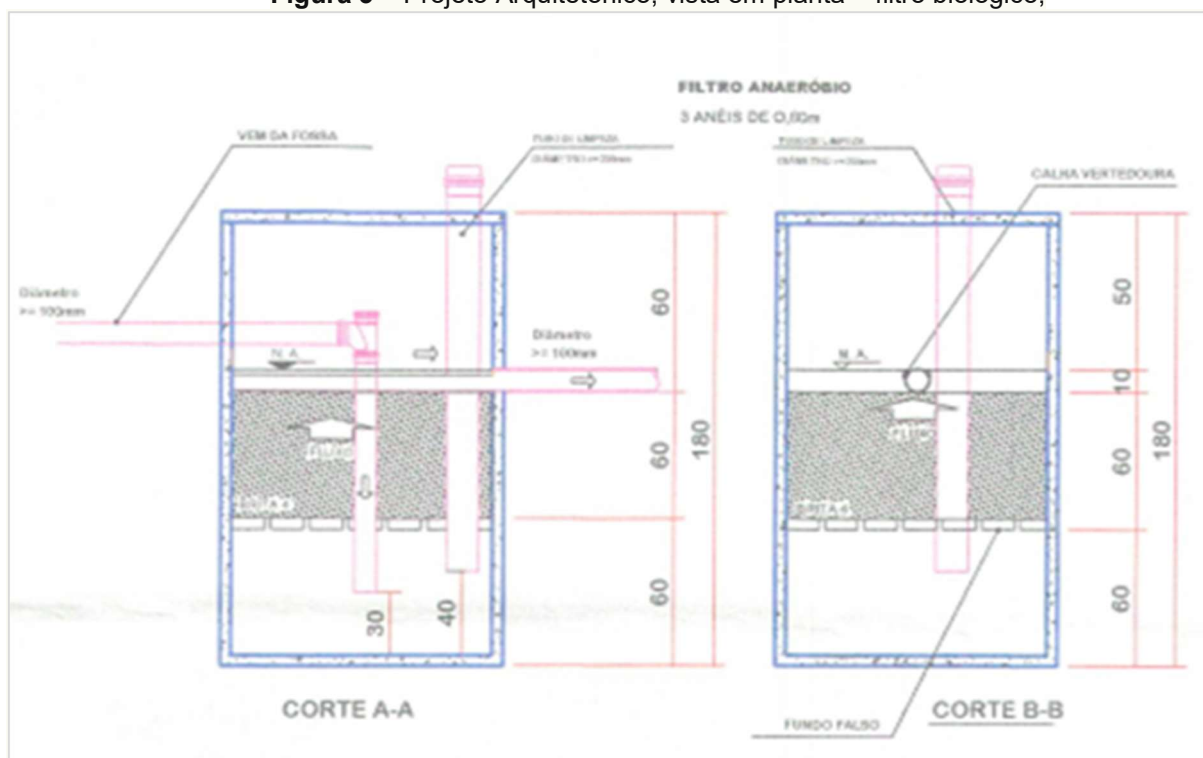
Projeto Arquitetônico, vista em planta – filtro biológico;
